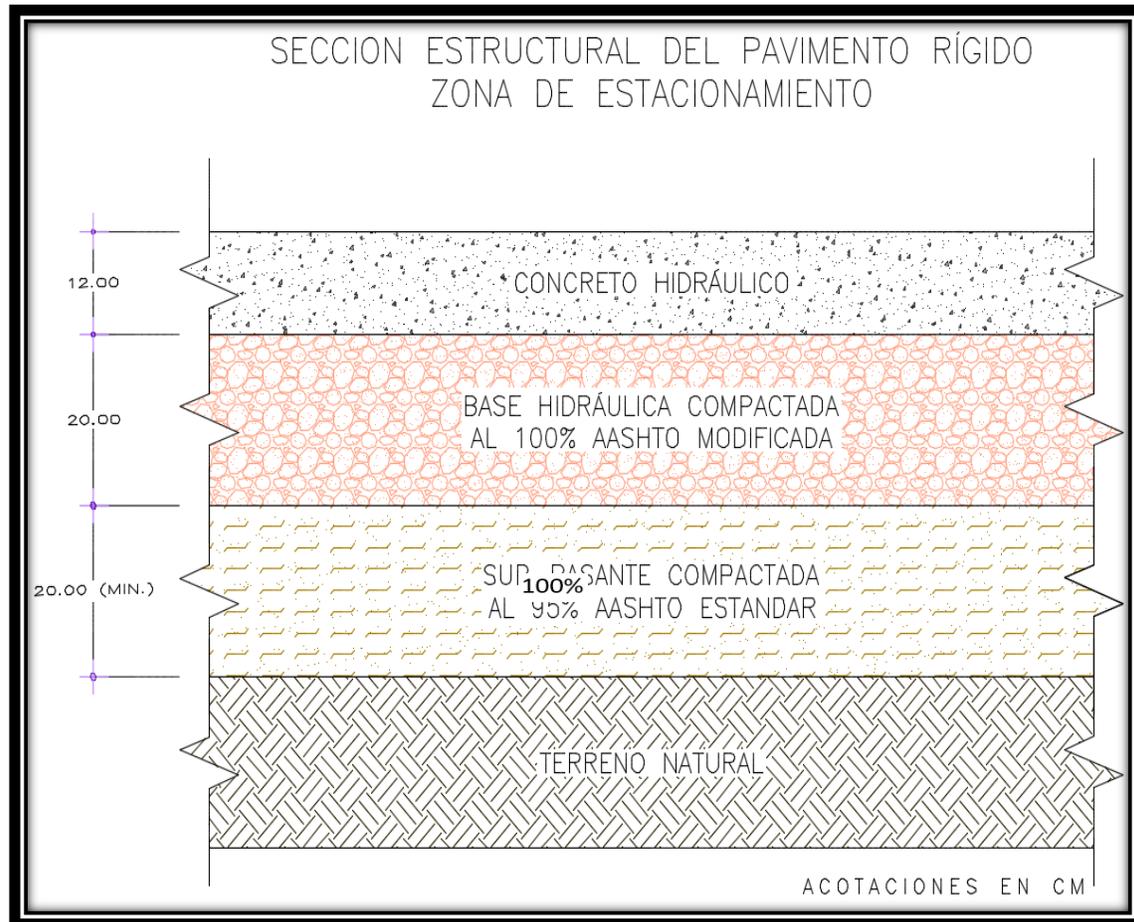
SECCION DEL PAVIMENTO EN ESTACIONAMIENTO
